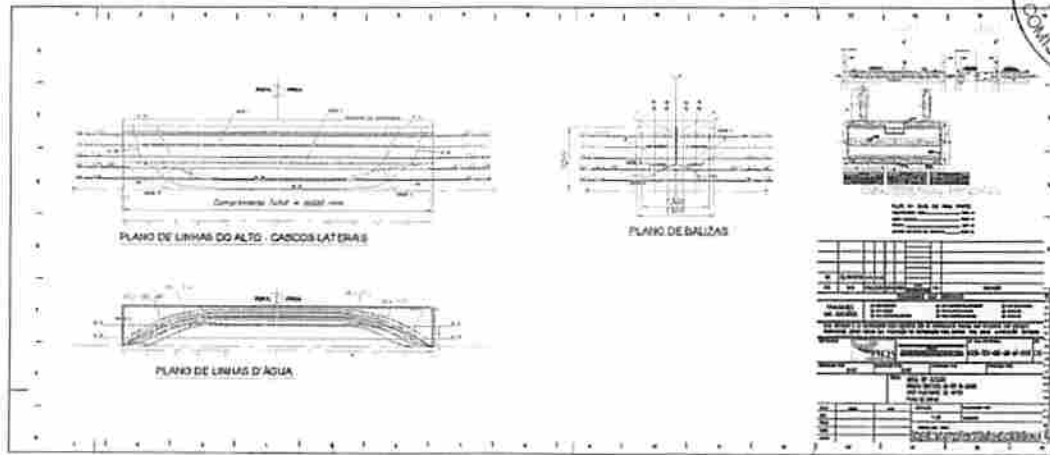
Plano de linhas – Casco Pieres de Apoio.
